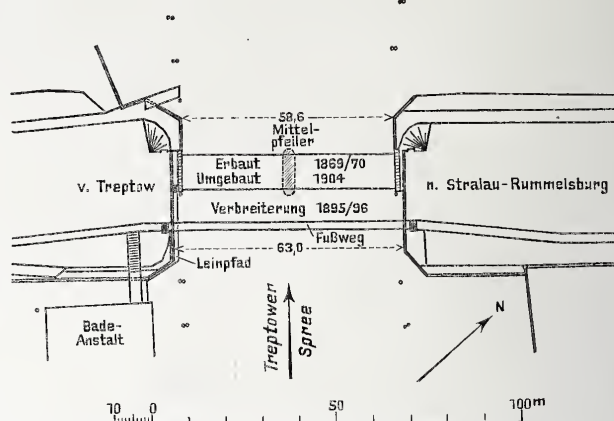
Lageplan der Eisenbahnbrücke bei Treptow.
